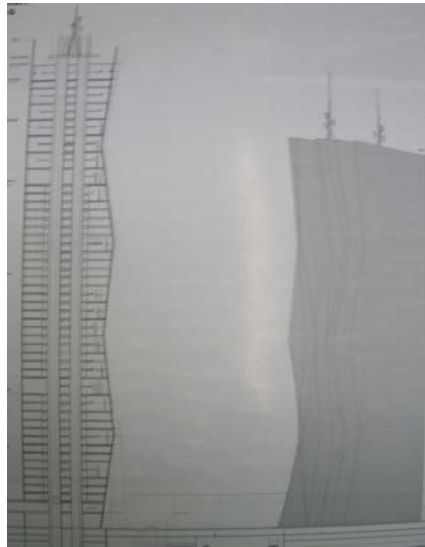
London Bridge Tower bina görünüşü (London Bridge Tower.;b.t.)
